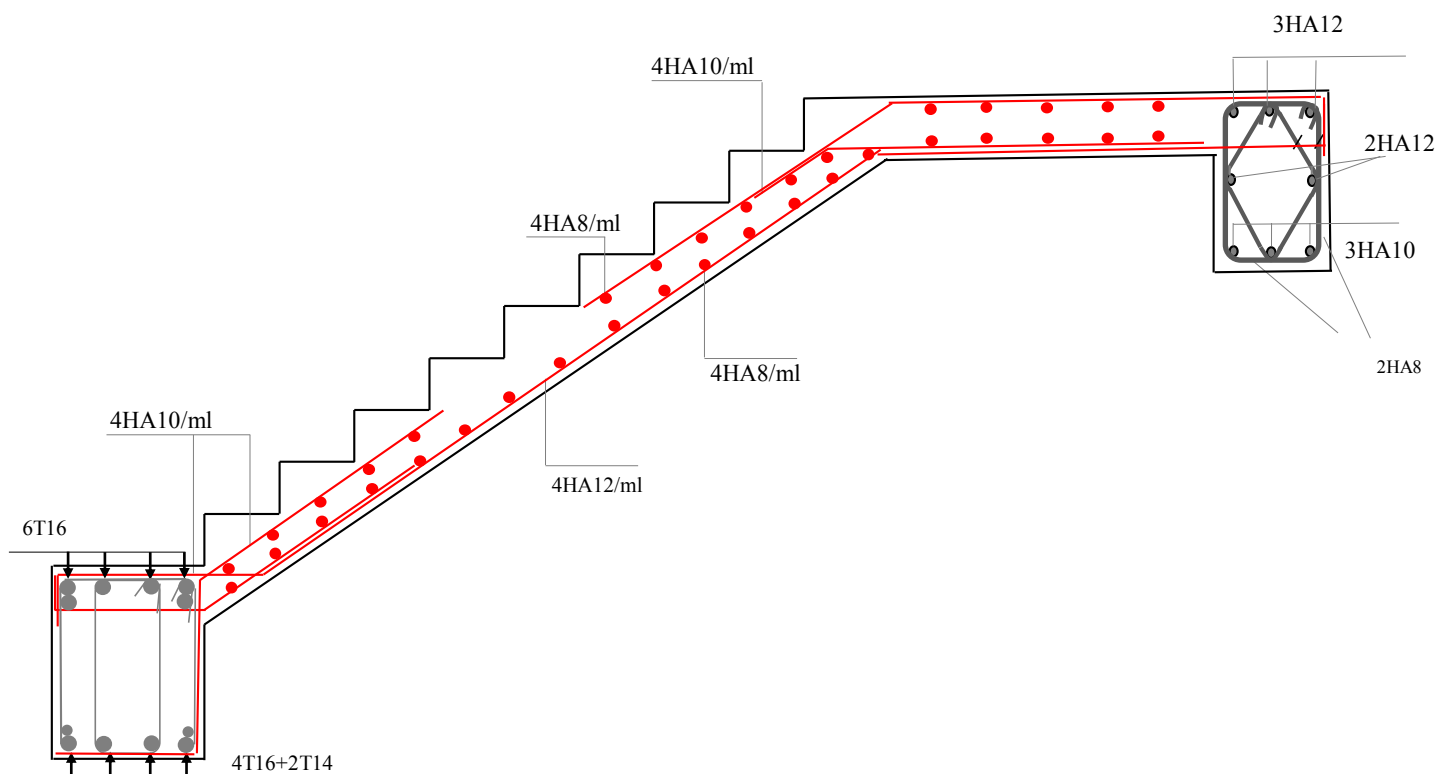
Schéma du Ferrailage de l'escalier Type 1(a).
